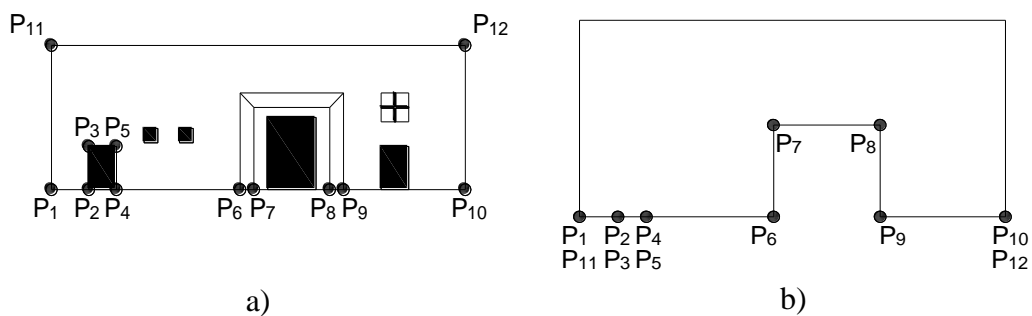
Localização dos pontos de controlo em a) alçado e em b) planta
